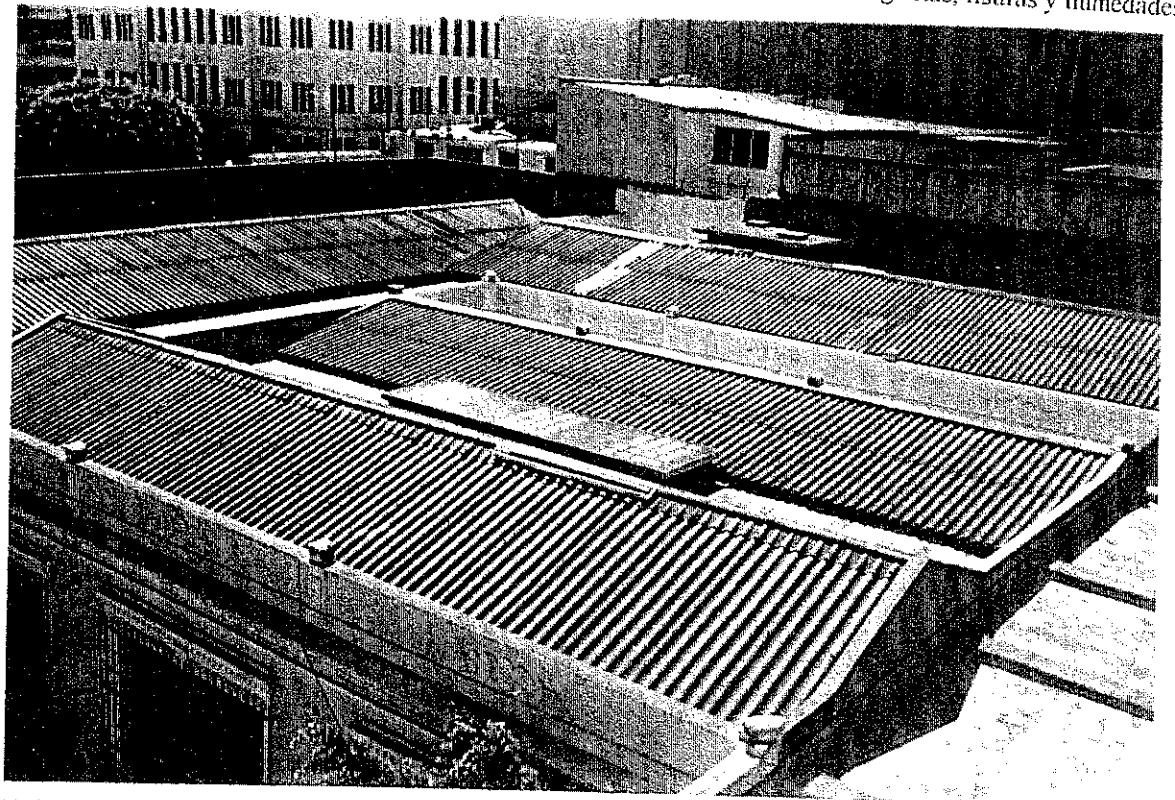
Vista de la cubierta de fibrocemento y La losa con grietas, fisuras y humedades
